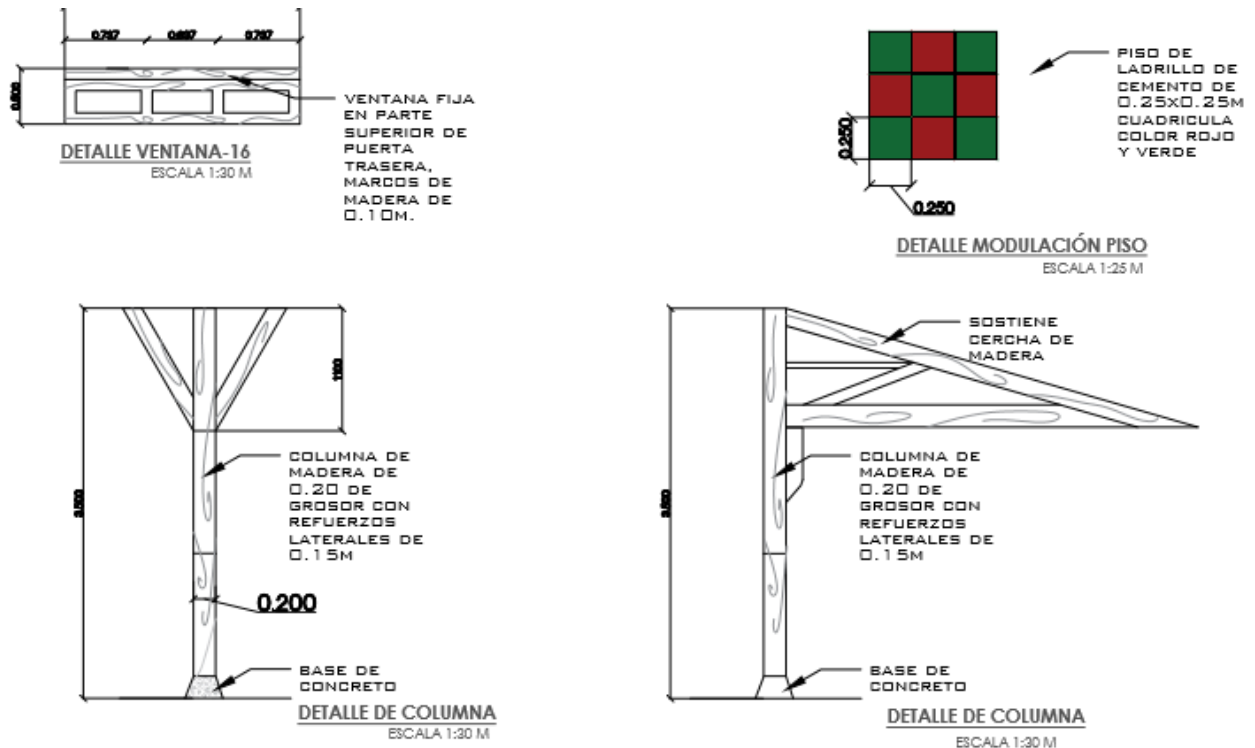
Resumen gráfico de detalles arquitectónicos.
